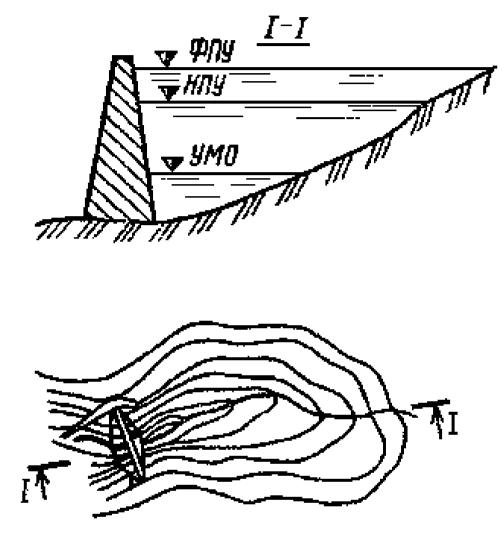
План и схематический продольный профиль водохранилища
